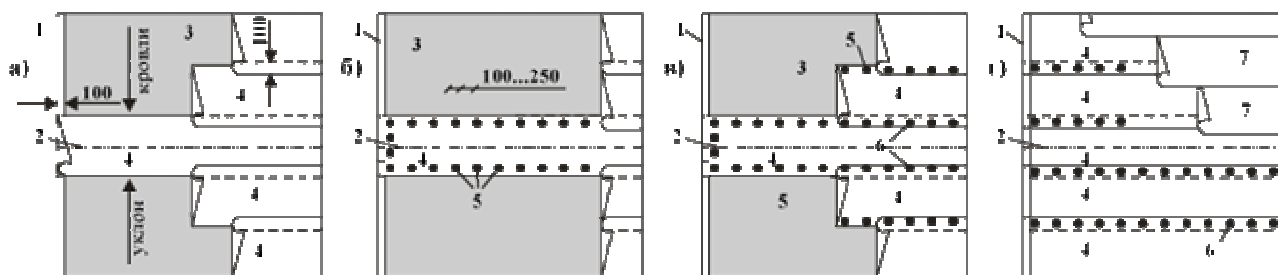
Укладка кровельного ковра без приклейки к основанию механическим способом:
